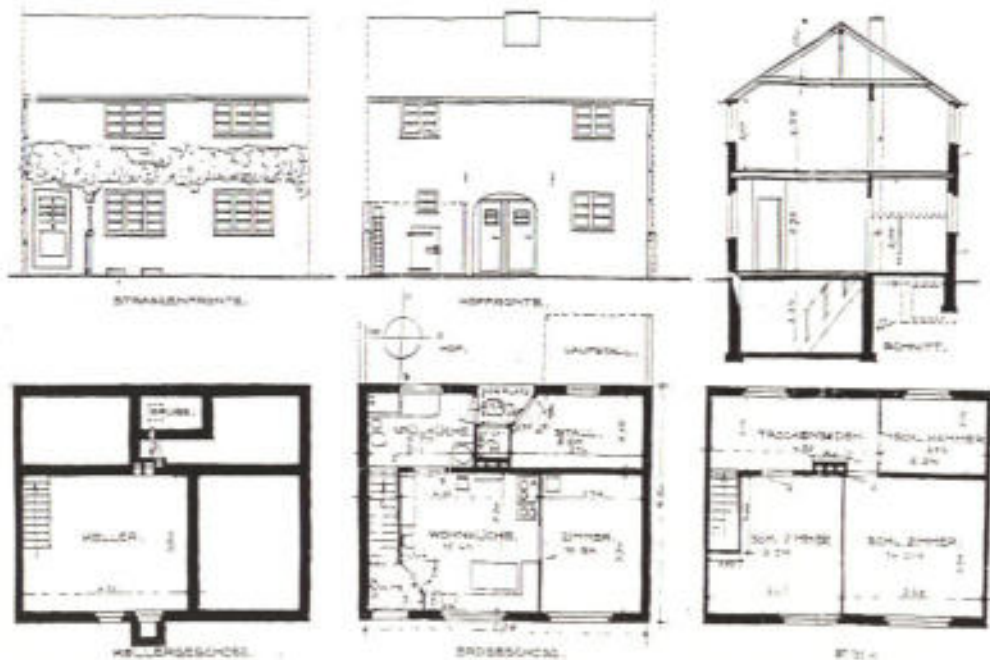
Wohnhaustyp Schulstraße; Grundrisse, Ansichten, Schnitt
